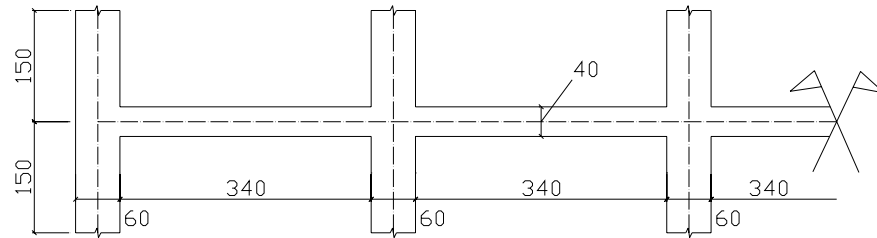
Geometria da viga, Caso 5 (dimensões em cm)
